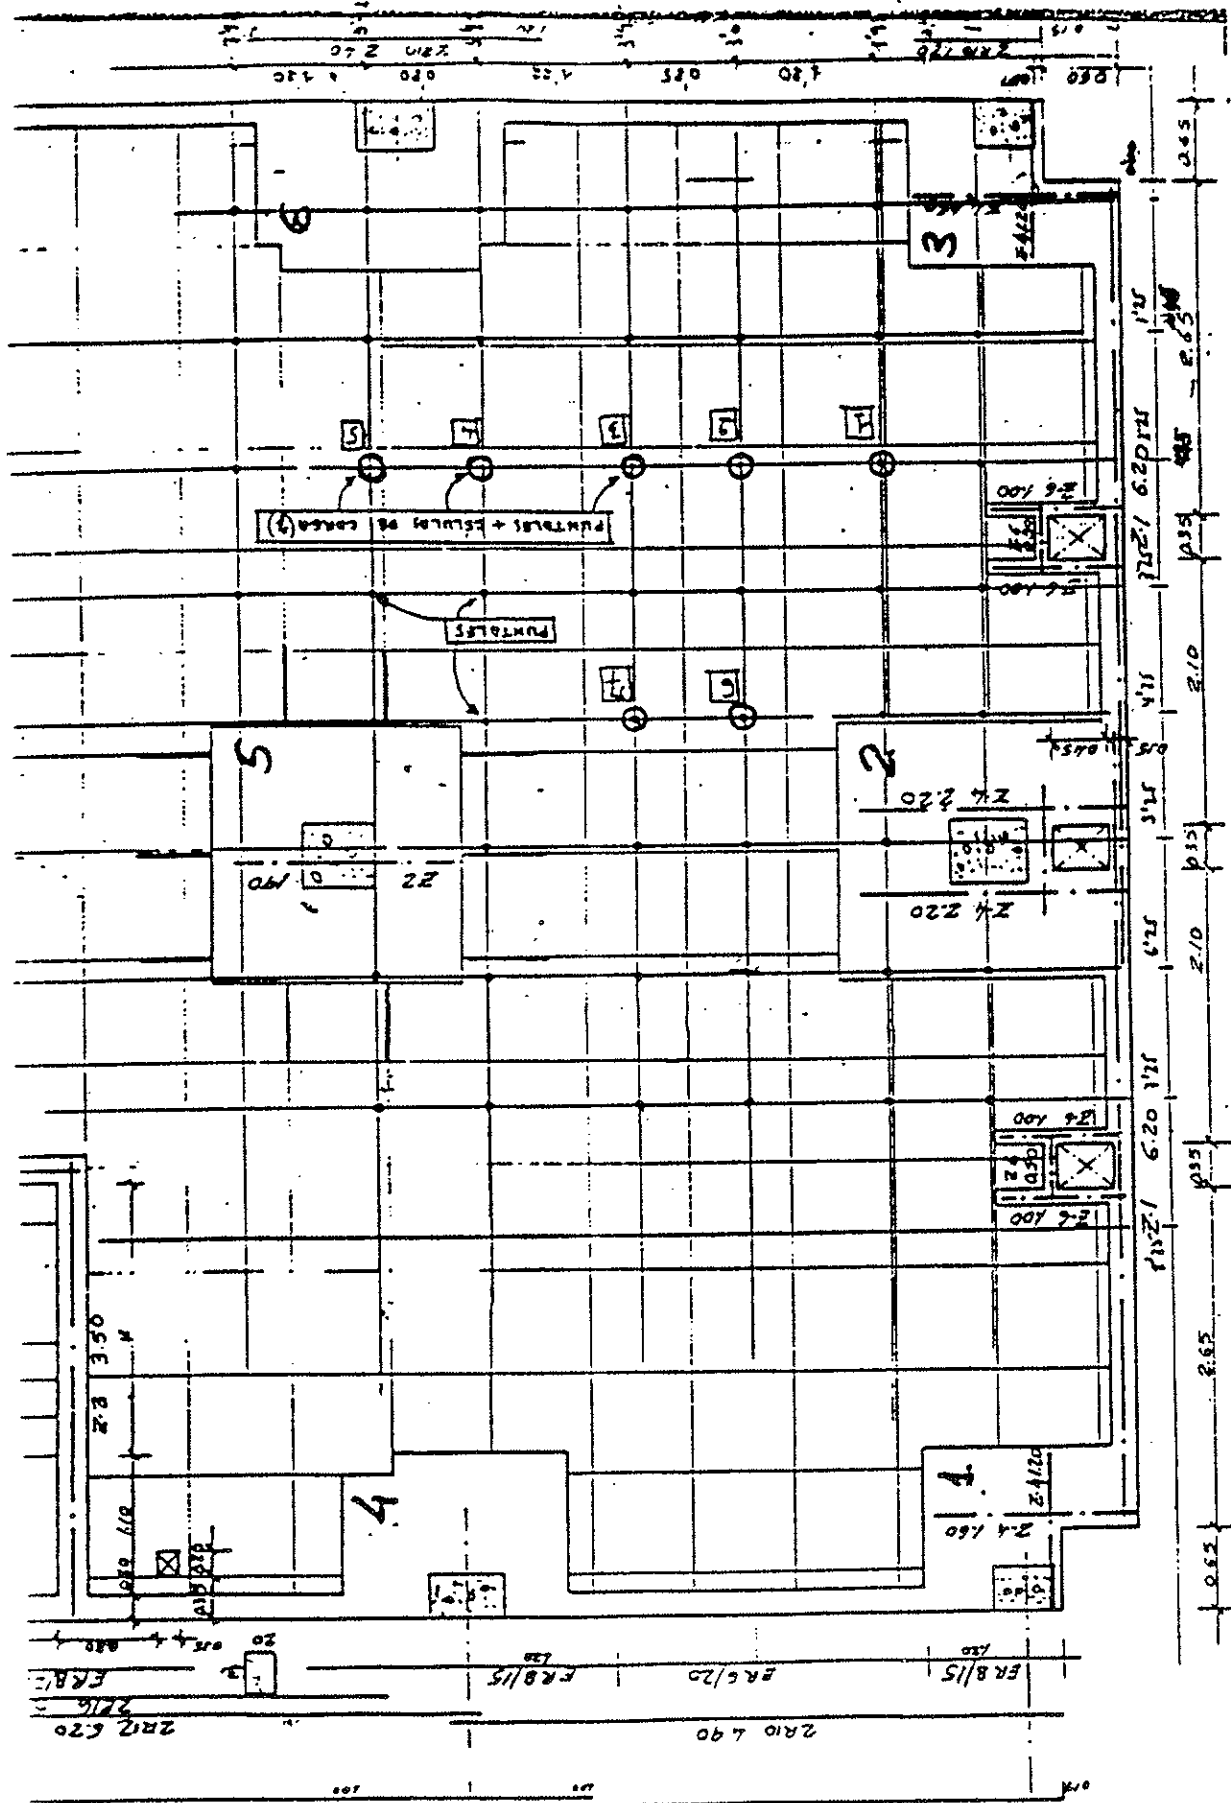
Planta de estructura y situación de puntales, en el edificio de Alicante.
